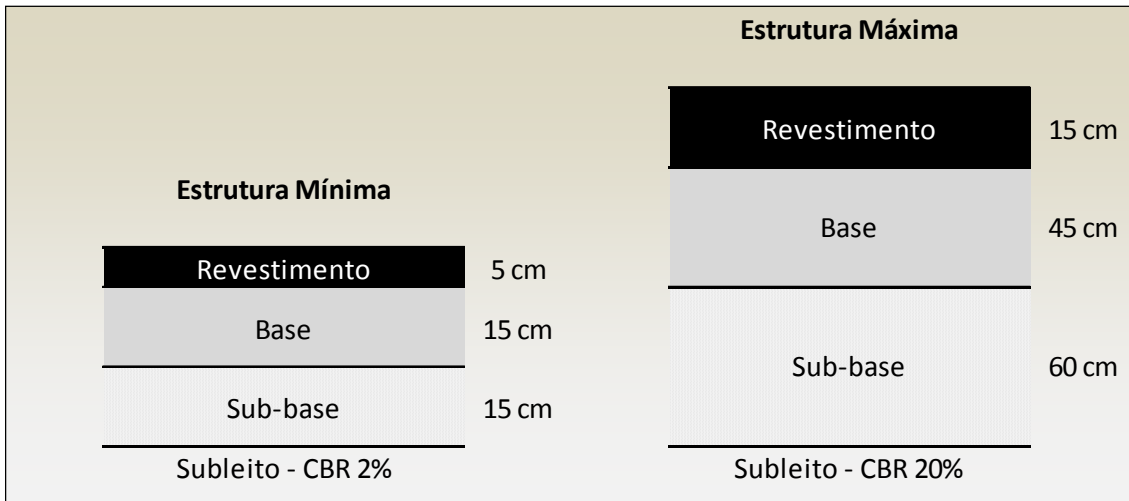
Estruturas mínima e máxima de pavimento asfáltico
